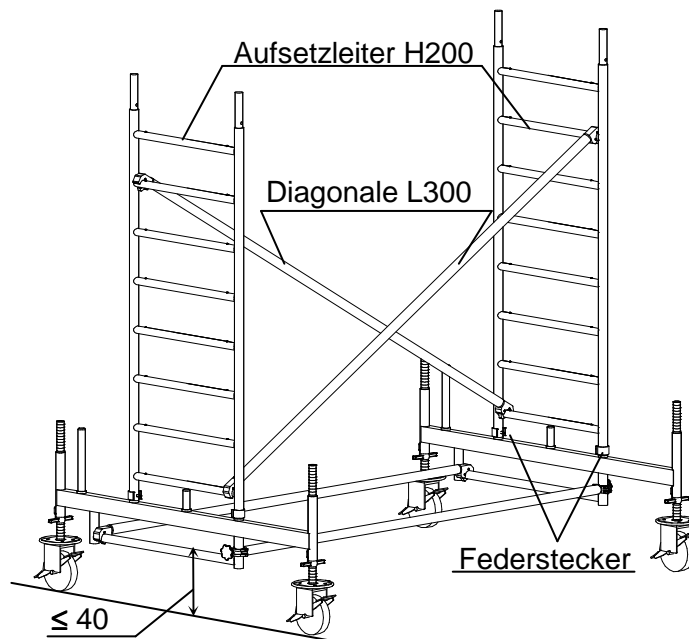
Grundeinheit mit Fahrbalken L180 – mittige Stellung
